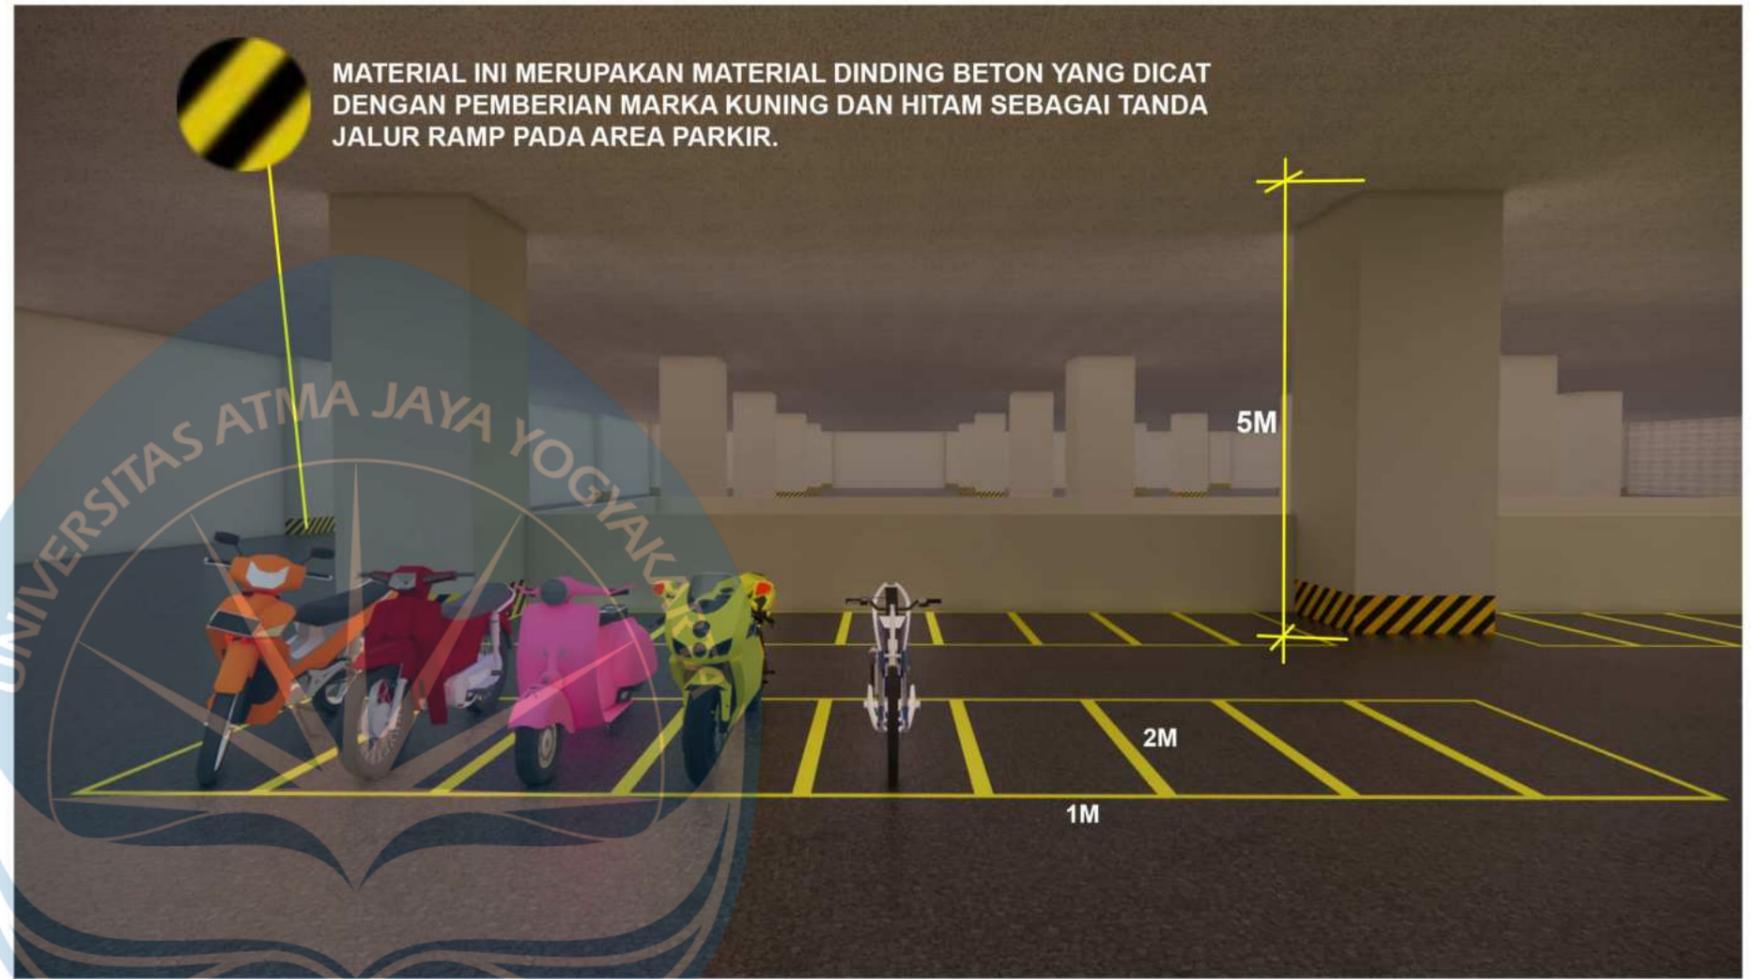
# DETAIL PENDALAMAN DESAIN (AREA PARKIR)
